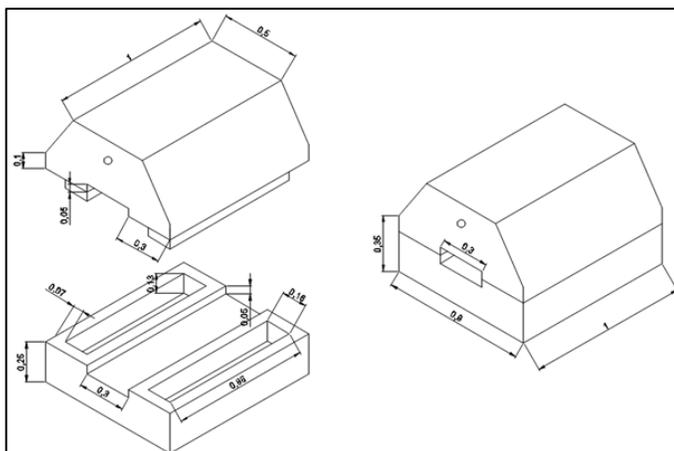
Detalle de muerto de anclaje.
